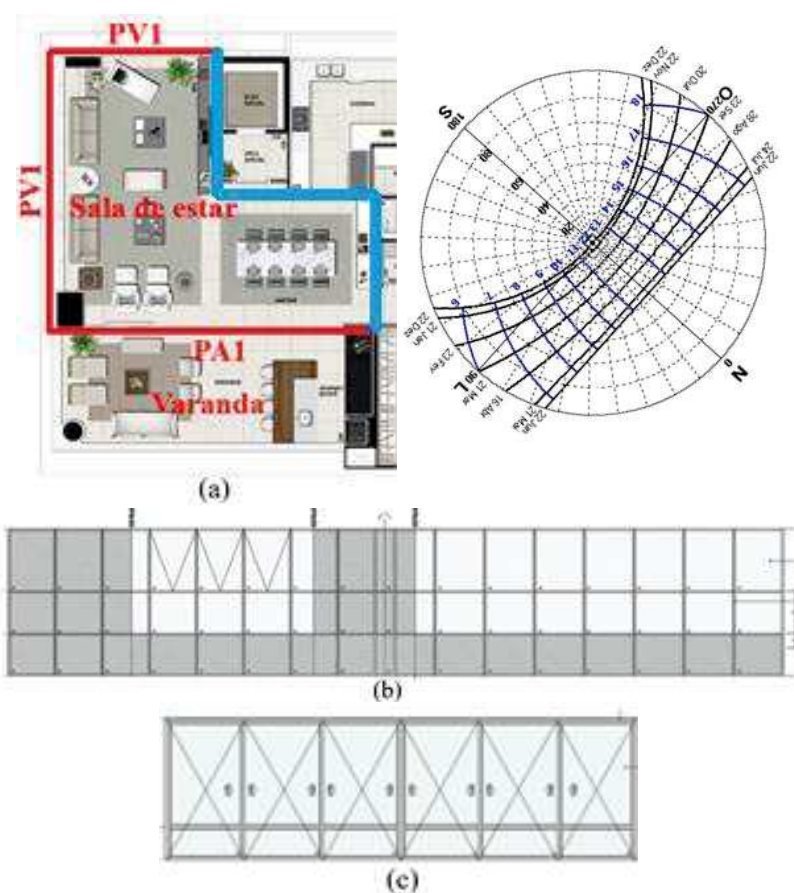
(a) Planta baixa da sala de estar e carta solar; (b) esquadria PV1 – fachadas sudoeste/sudeste; e (c) esquadria PA1 – fachada nordeste (adaptado de arquivo da construtora).
